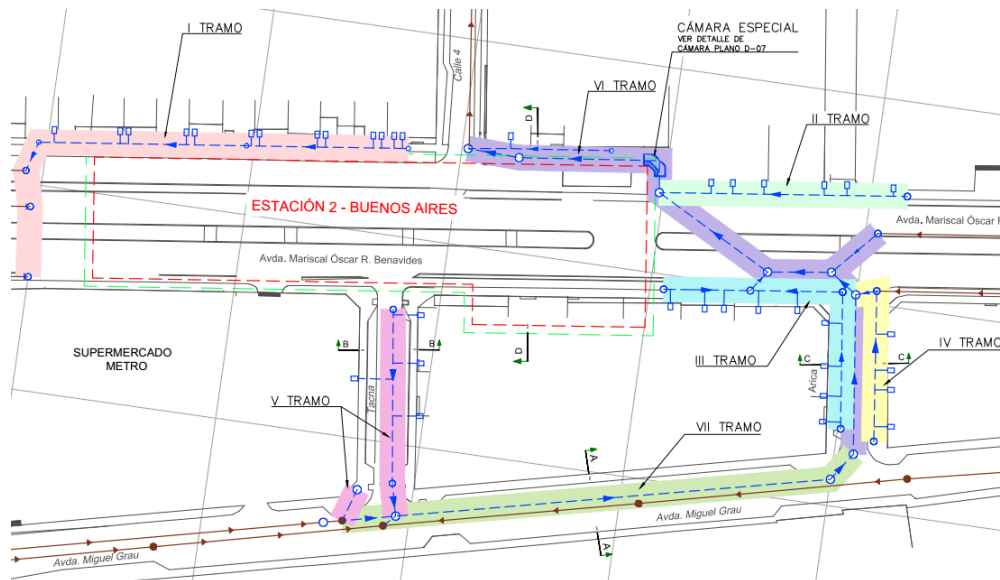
Tramos constructivos del proyecto de reubicación de alcantarillado en la E2
